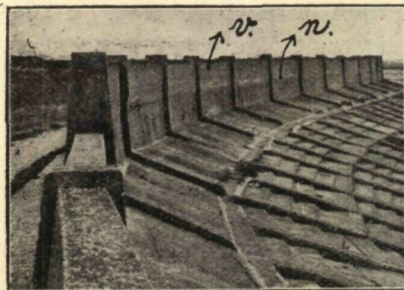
Une murette d'exhaussement *n* d'une digue de mer bâtie en 1907, à nouveau rehaussée avec du béton *v* en 1912 (photo 1931).
